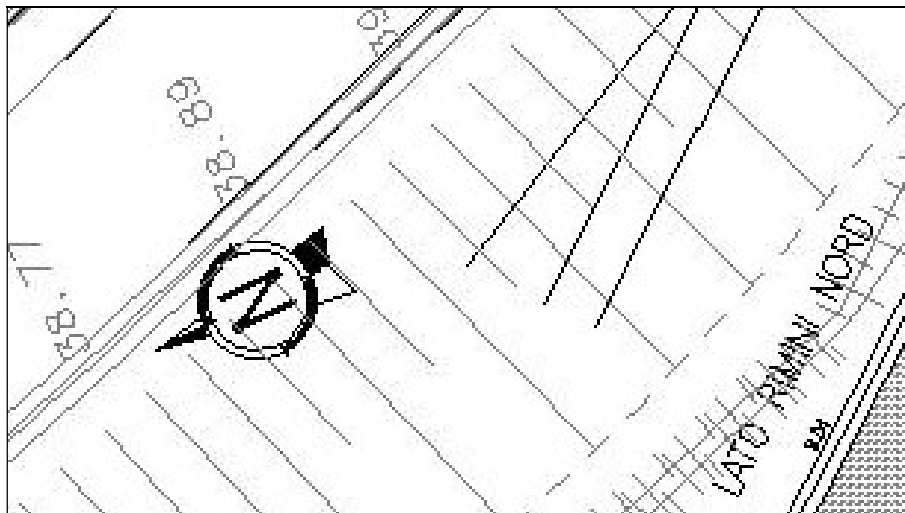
Posizione planimetrica del muro andatore lato Rimini – Allargamento Nord
